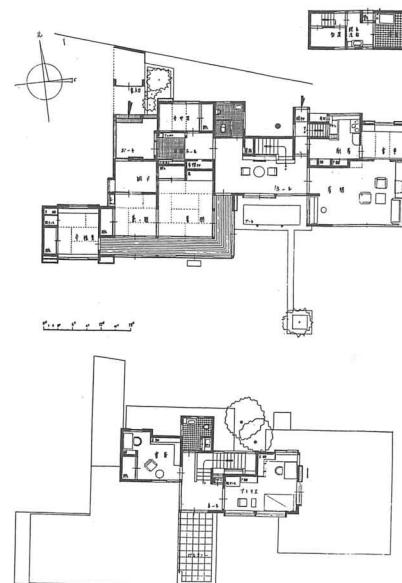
金子邸 1階・2階平面図 (上)、地階平面図 (下)
